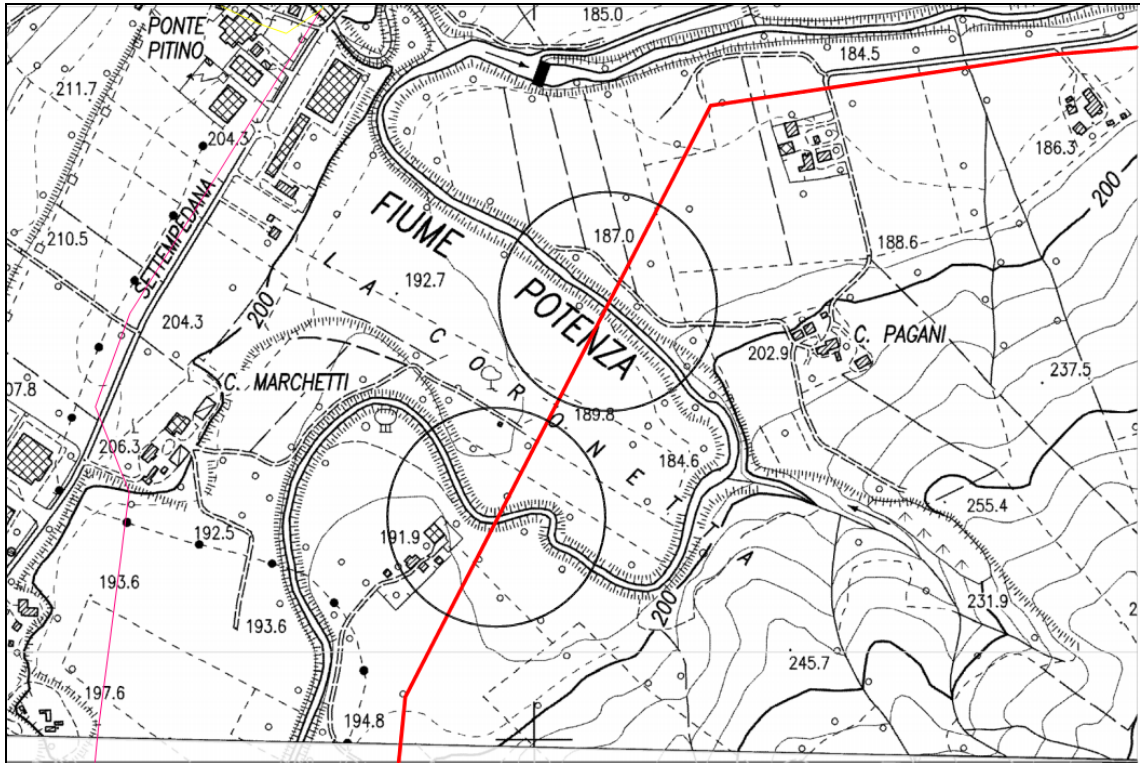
Stralcio Planimetrico in scala 1:10 000 – 2° e 3° Attraversamento
